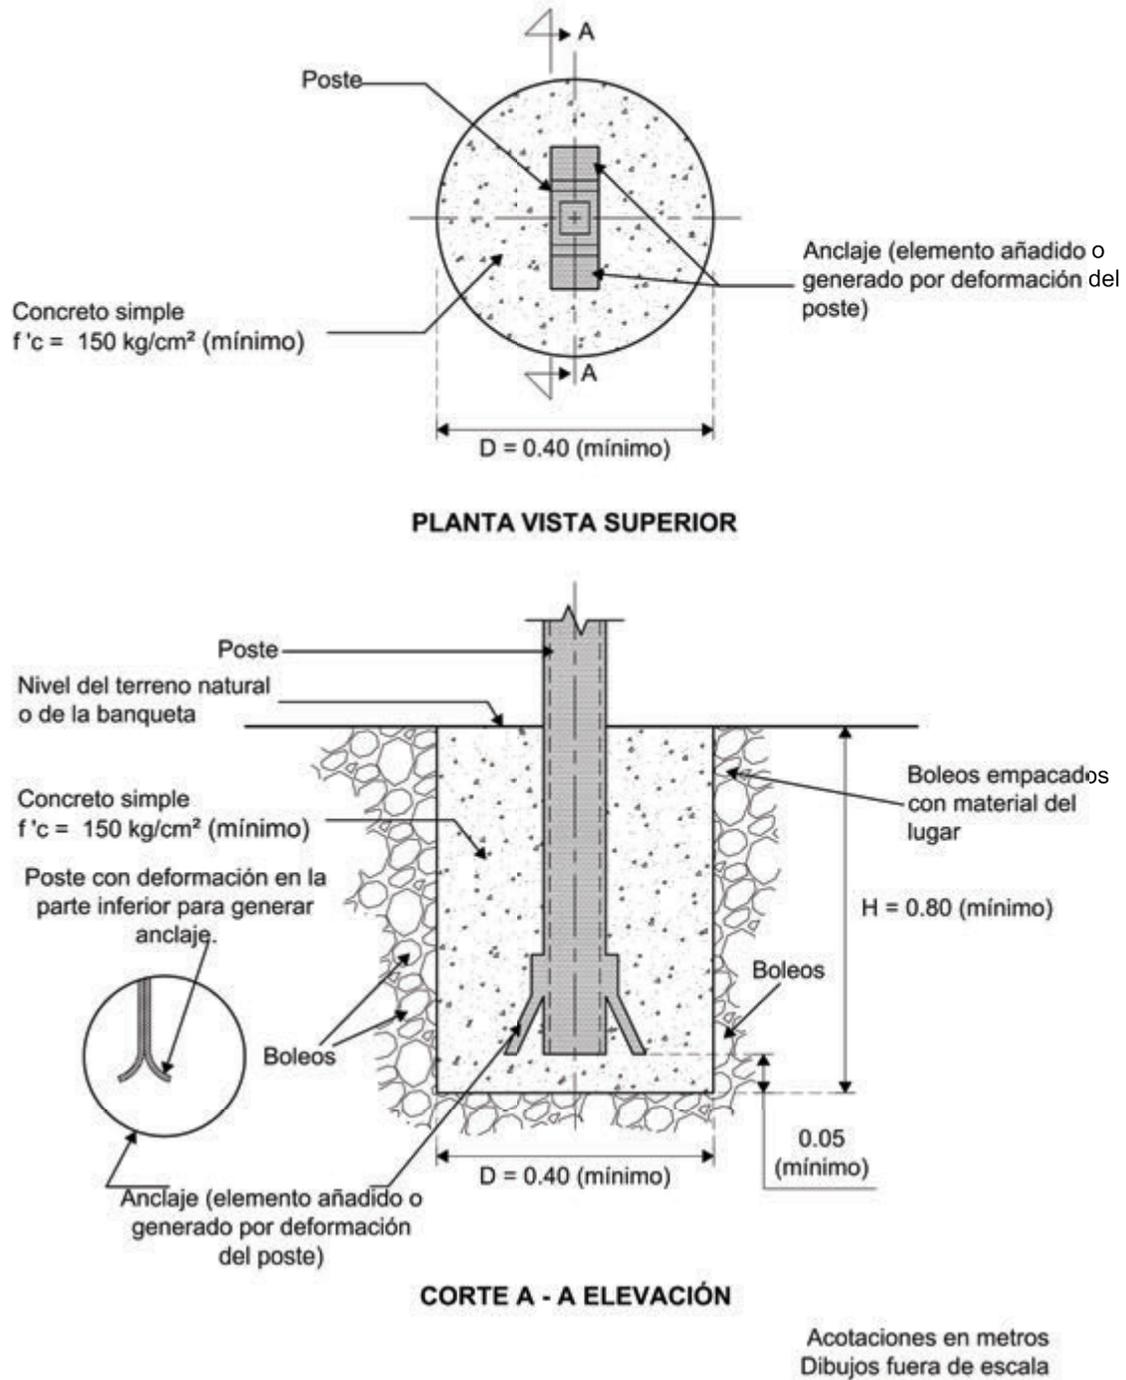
Cimentación tipo para los postes de las señales bajas
